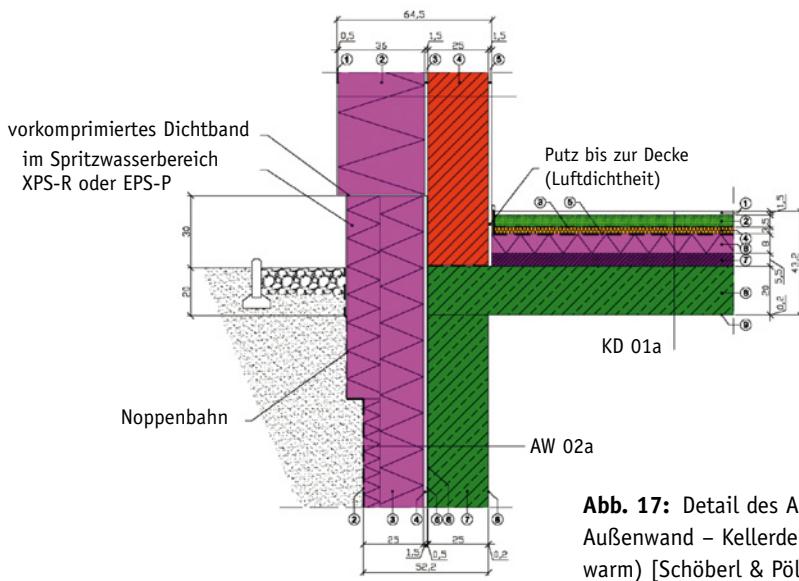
Detail des Anschlusses Außenwand – Kellerdecke (Keller warm) [Schöberl & Pöll GmbH]
